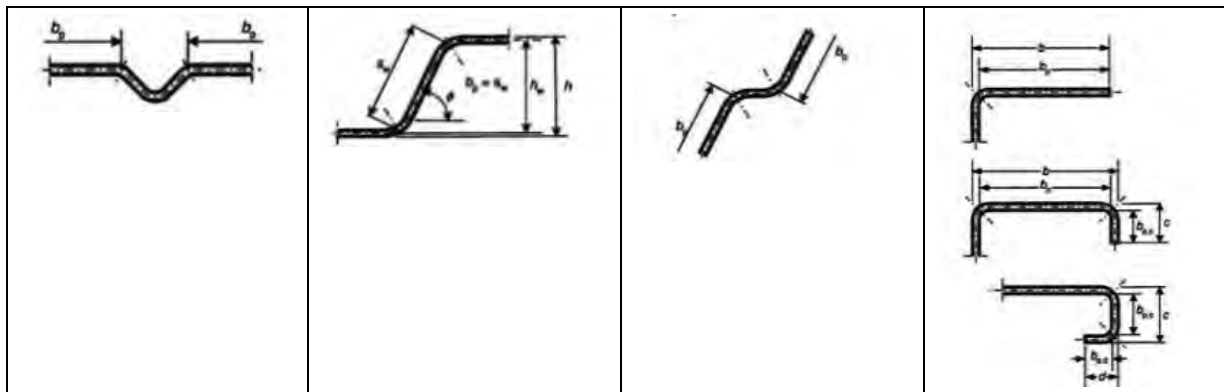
Esempi di determinazione della larghezza b_p
